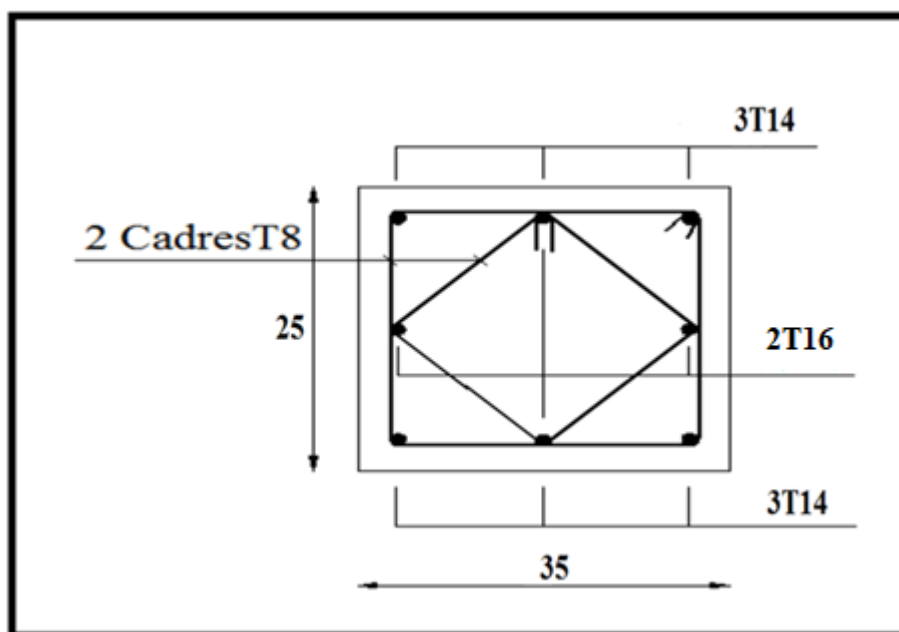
Schéma de ferrailage de la poutre palière.
